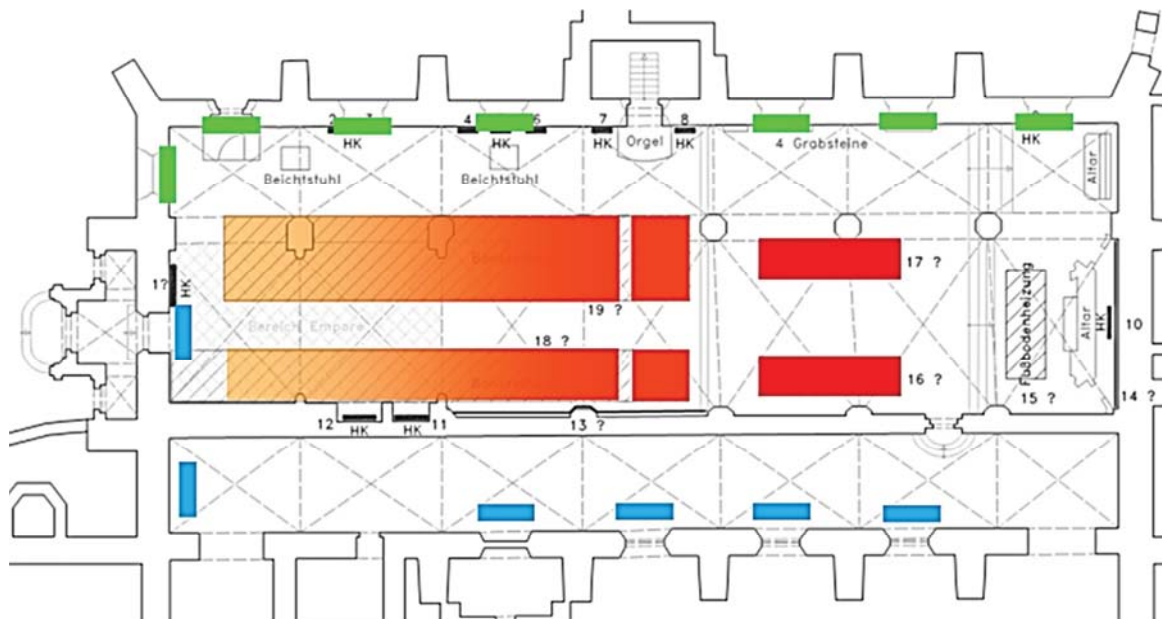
Grundriss Klosterkirche mit empfohlenen zukünftigen Heizungssystem
